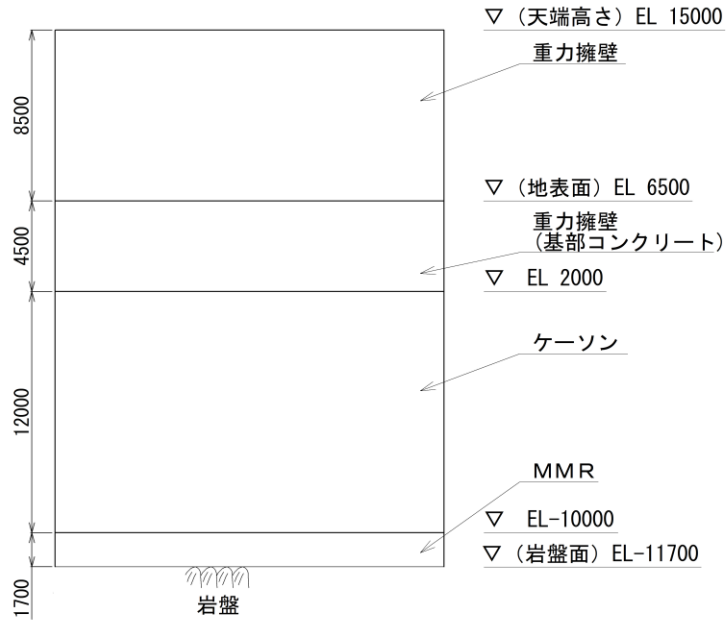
(1) 防波壁（波返重力擁壁）の構造図（正面図）（ケーソン設置部）
